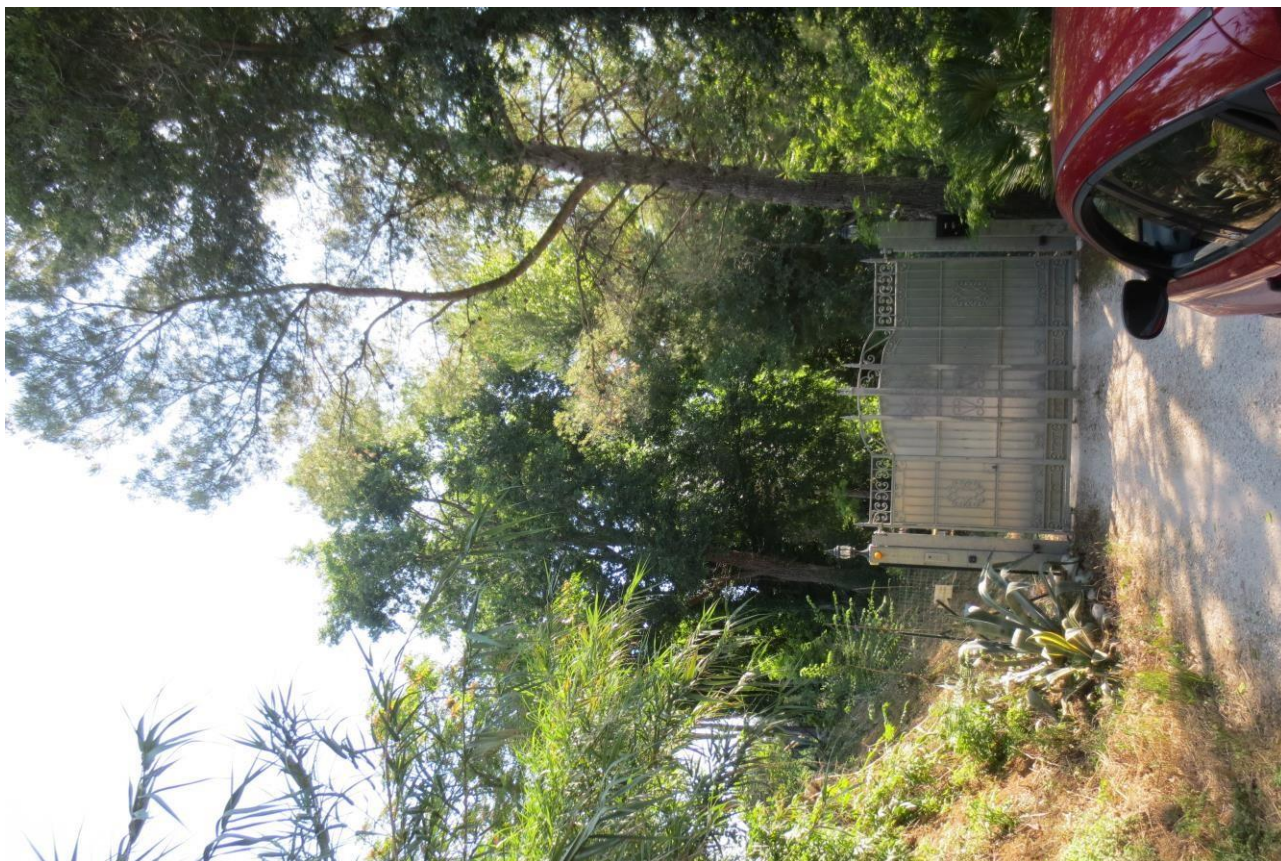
LOTTO N. 6 - Interruzione strada di accesso
